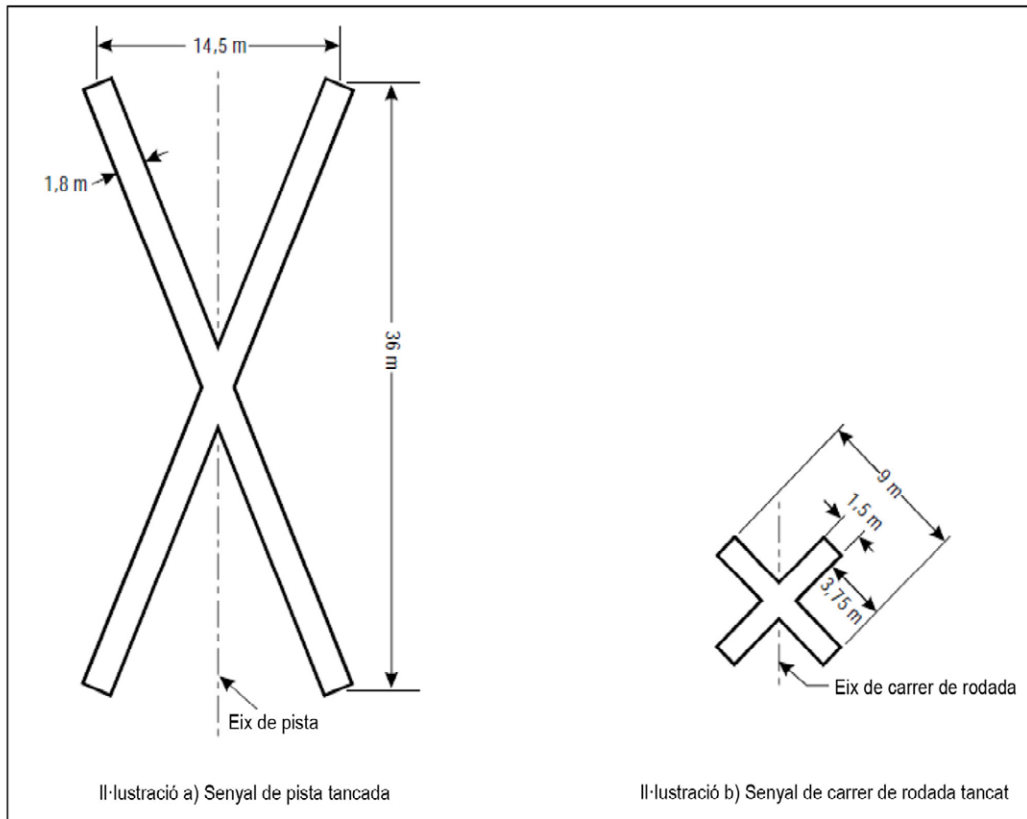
Senyals de pista i de carrer de rodada tancats
